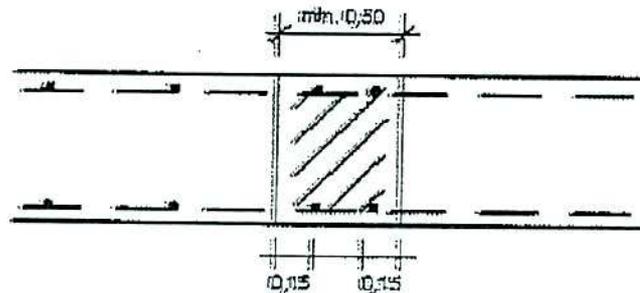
Condizione di fissaggio tra reti sovrapposte
